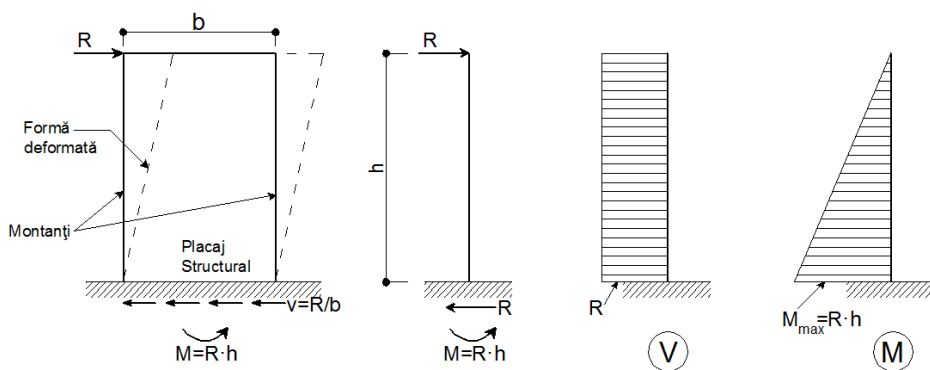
Schema statică și diagramele de moment încovoietor și forță tăietoare a unui perete structural [2]: R – Reacțiuni de la planșeu/forța tăietoare de la baza peretelui structural; b – lățimea peretelui structural; h – înălțimea peretelui structural; v – reacțiunea (forța tăietoare) pe unitate de lungime din lățimea peretelui structural; M – moment încovoietor.
